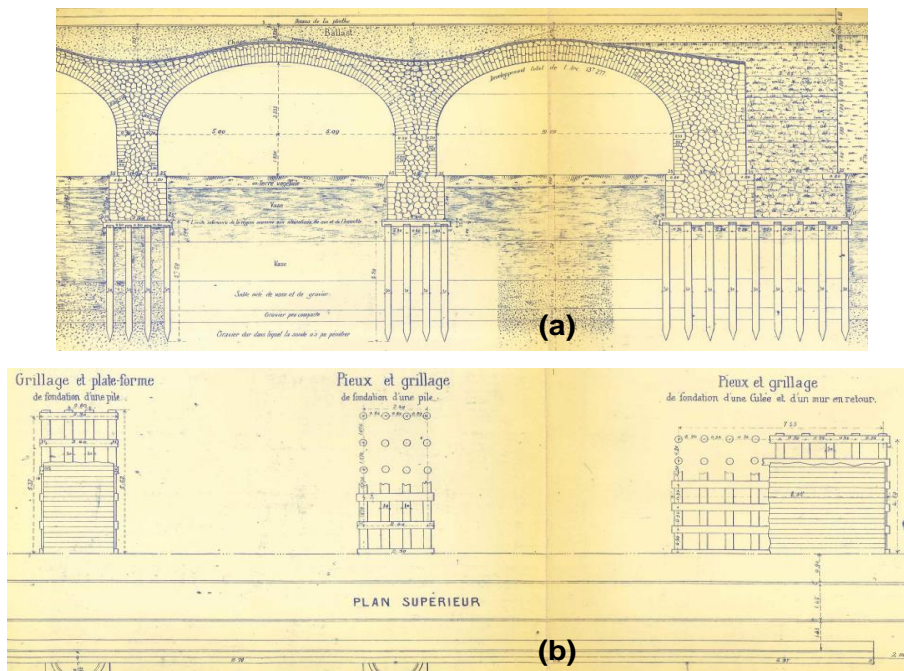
Coupe longitudinale des fondations (a) et vue en plan des fondations (b) (plans d'archives)
